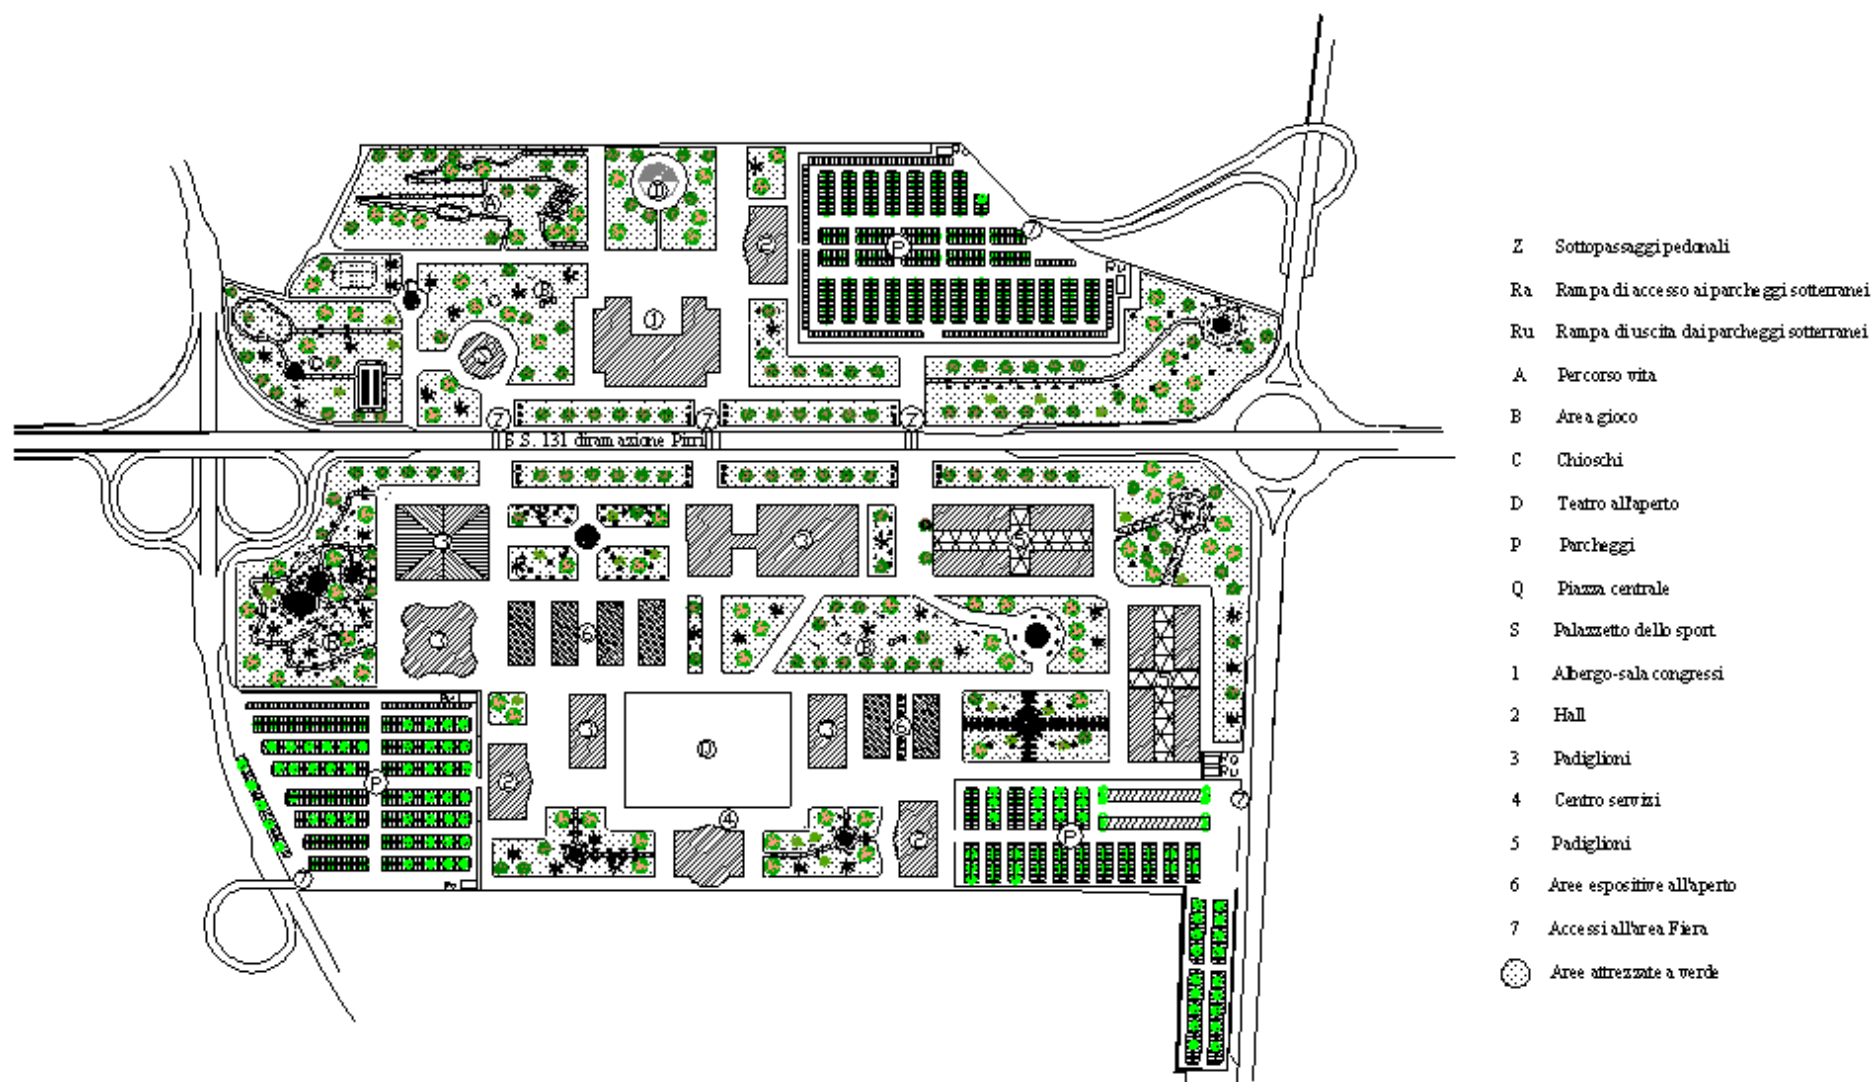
Planimetria della nuova Fiera secondo il Piano B
